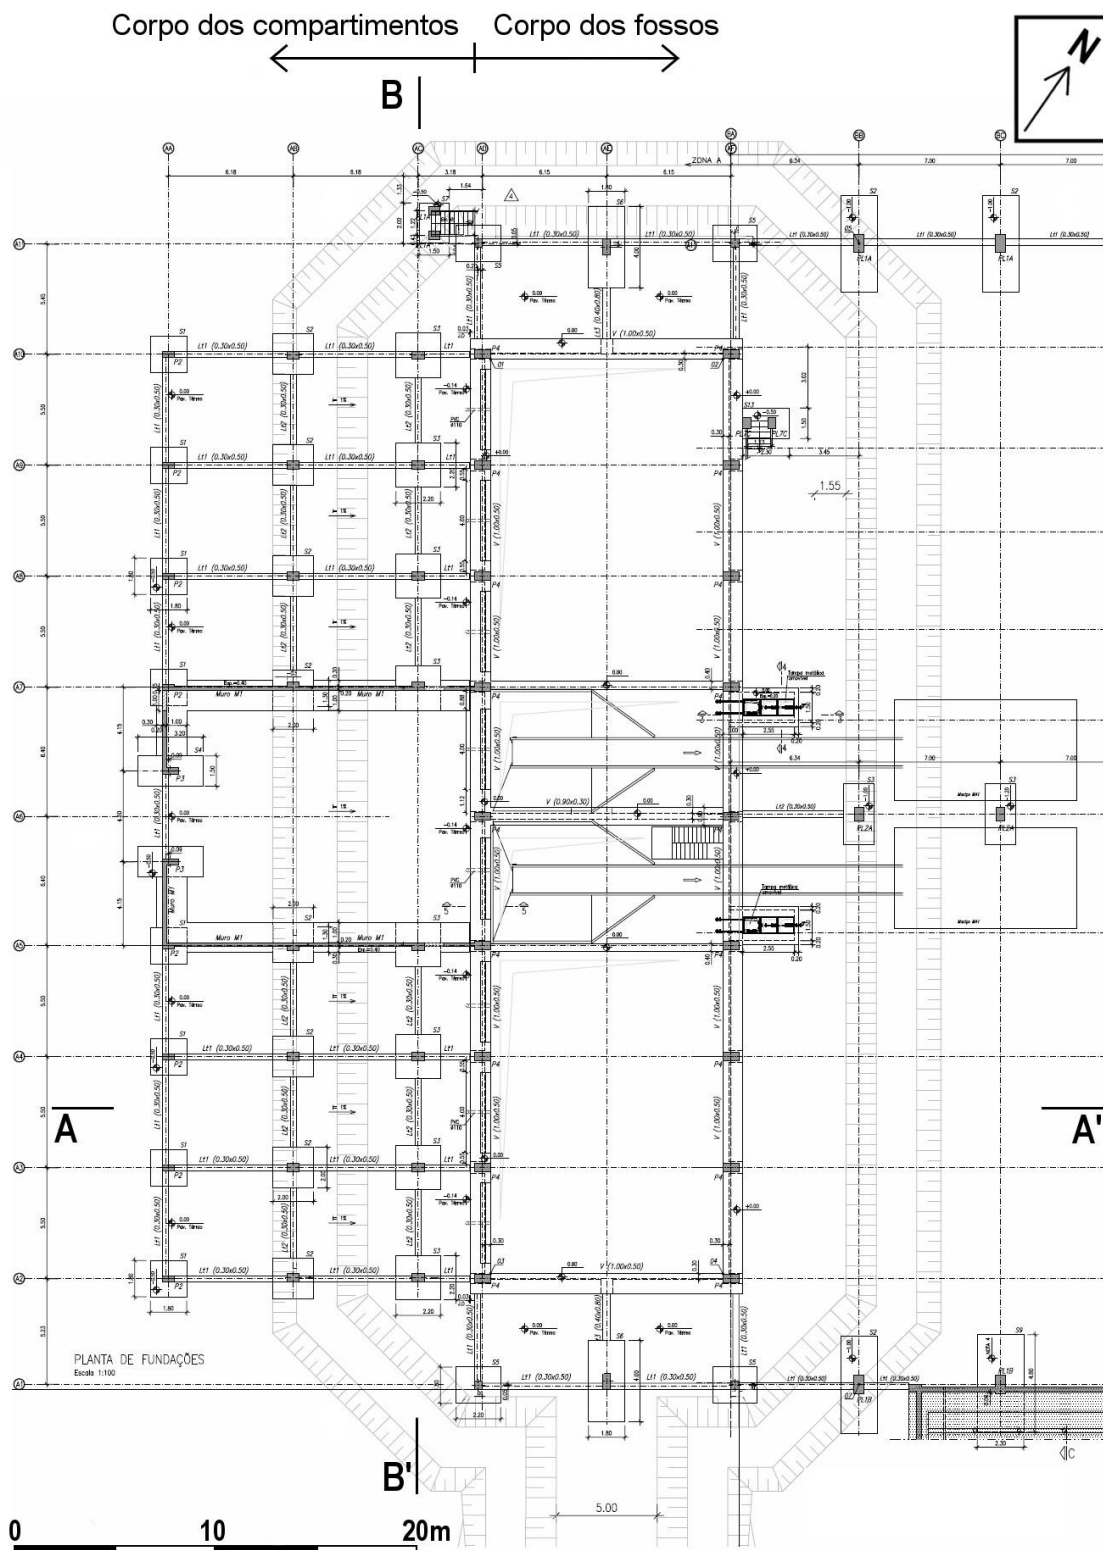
Planta de fundação da Zona 1 (adaptado de Edifer, 2011b)
